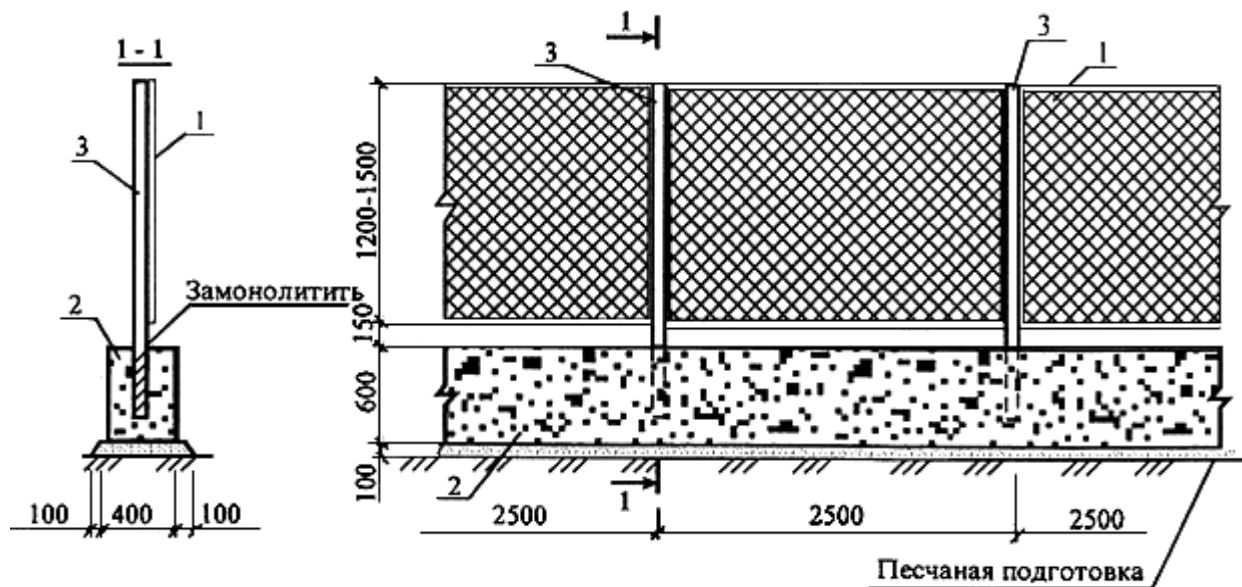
Унифицированные инвентарные ограждения строительных площадок с использованием:
